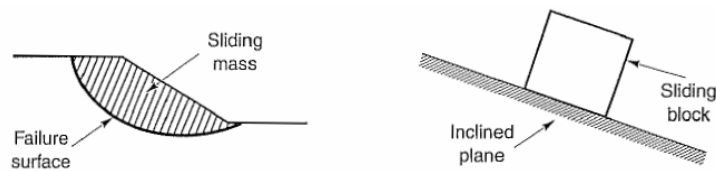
Schematizzazione della massa instabile secondo Newmark.
